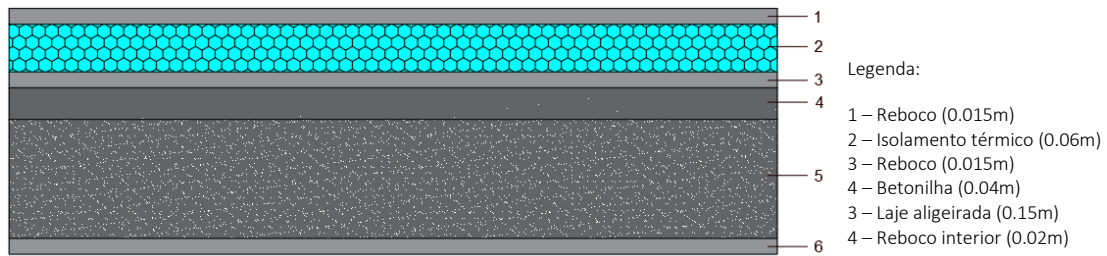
Pormenor construtivo referente à solução construtiva isolamento na esteira horizontal na face superior
